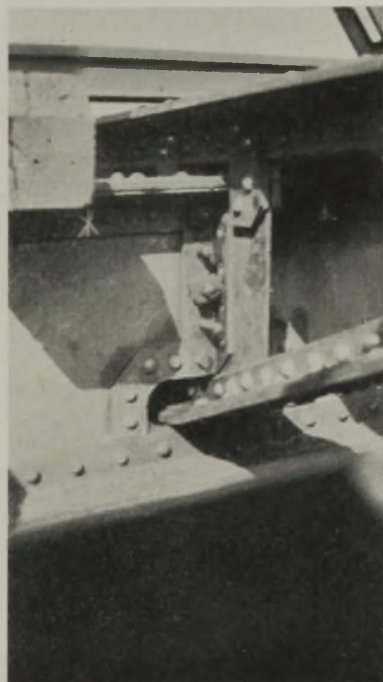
Die Verbindung des Längsträgers mit dem neuen Querträger.
